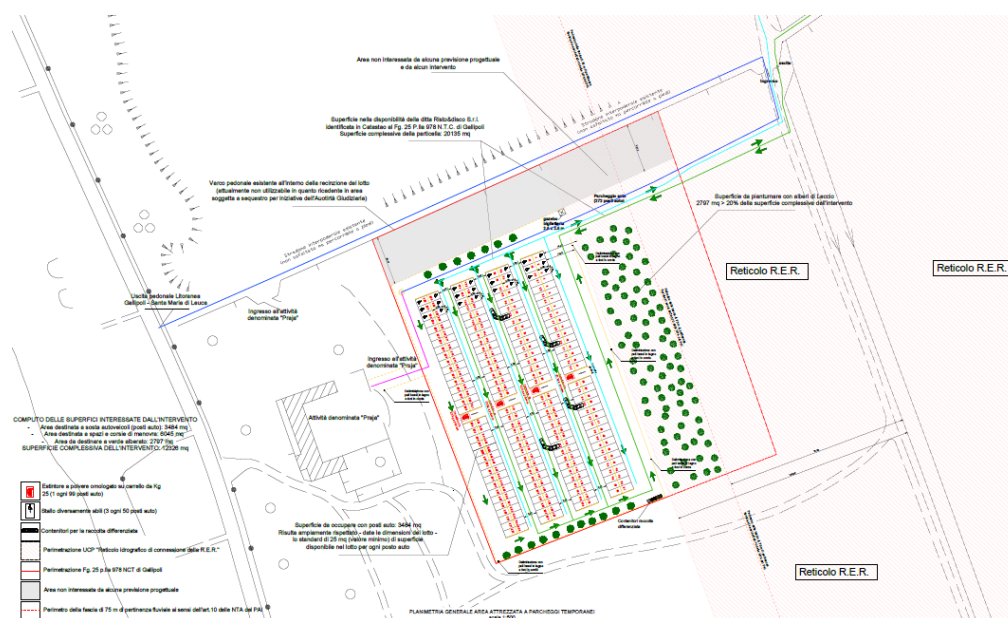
Stralcio Tav. 03 Elaborato Grafico di progetto Integrazioni. Planimetria generale area attrezzata a parcheggi temporanei.
